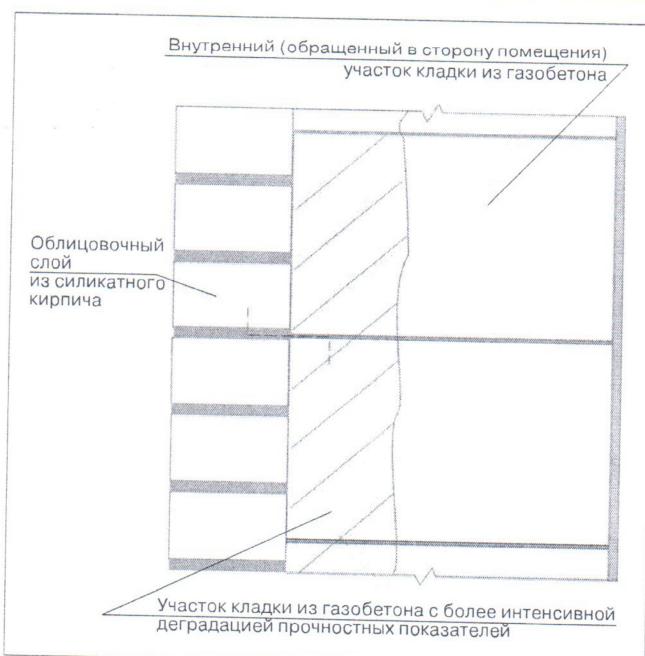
Схема разрушения испытываемой стеновой конструкции
